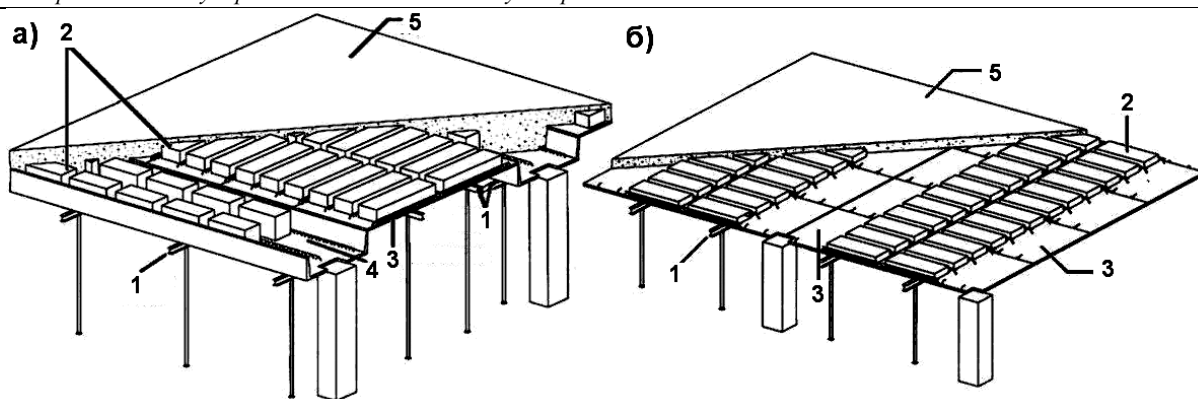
Filigree Wideslab System; а) с балочными перекрытиями; б) с безбалочными перекрытиями: 1 – временные опоры; 2 – полистирольный вкладыш; 3 – плоские керамзитобетонные плиты; 4 – керамзитобетонные плиты корытного профиля; 5 – монолитный бетон
